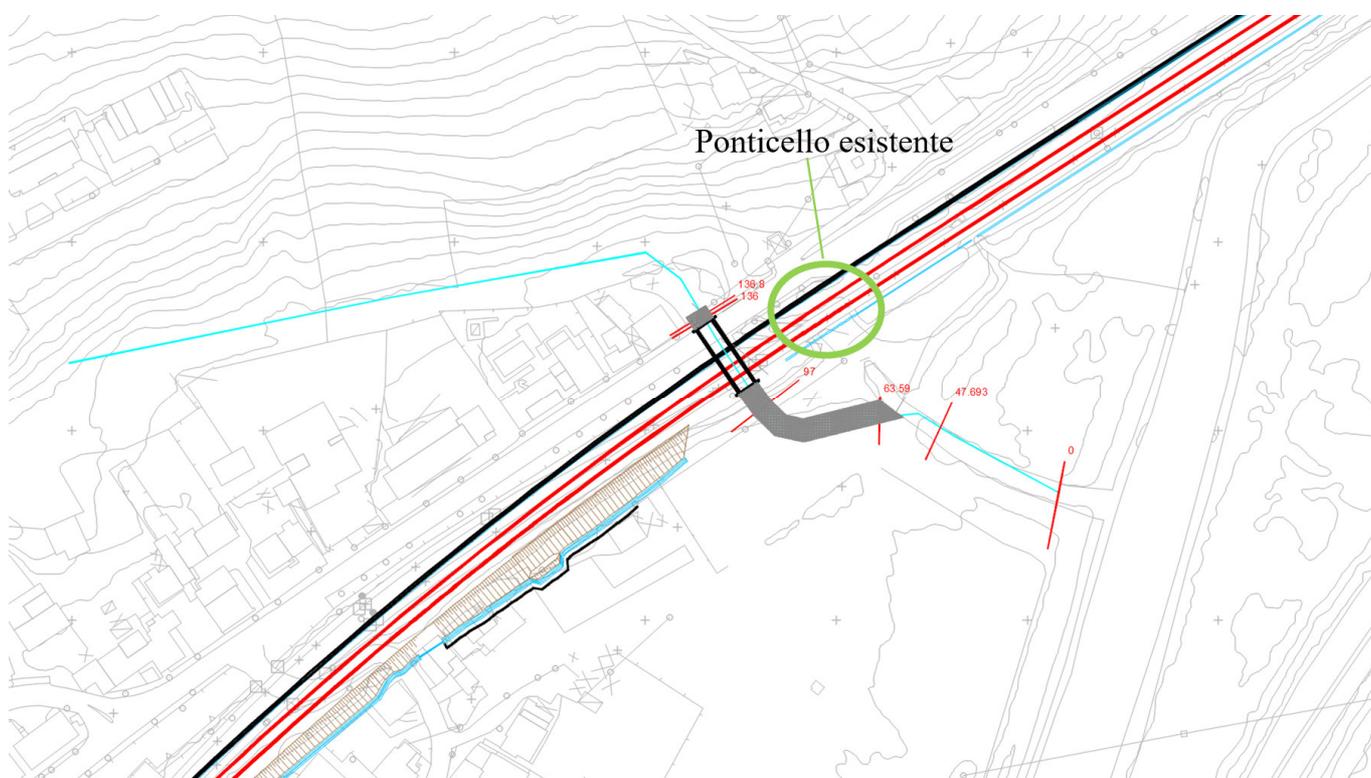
Schema planimetrico dell'asse IN08 e delle sezioni trasversali in condizioni Post Operam
